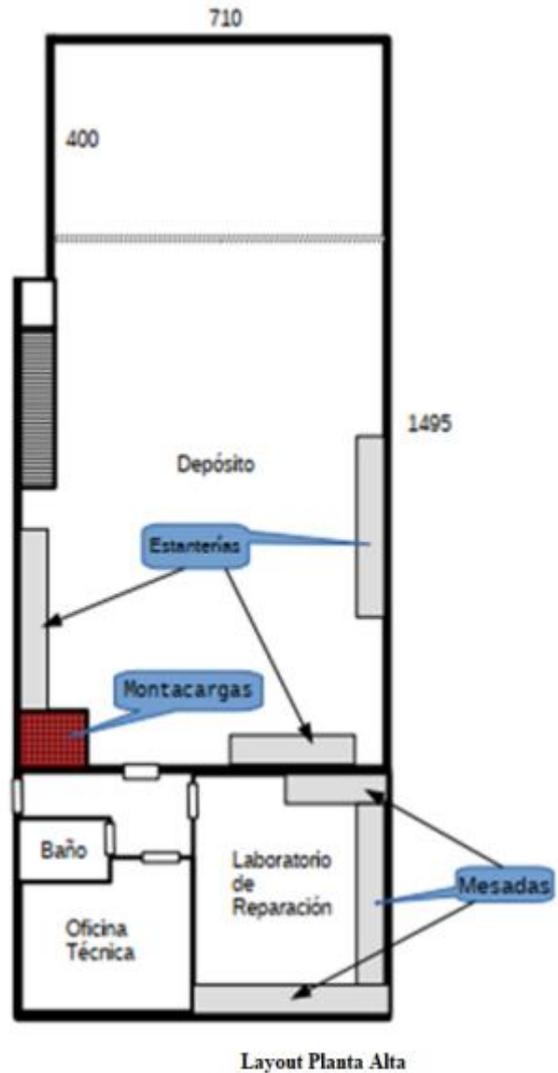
Planta alta actual de la planta de tratamiento de RAEE. Fuente: Propia.
